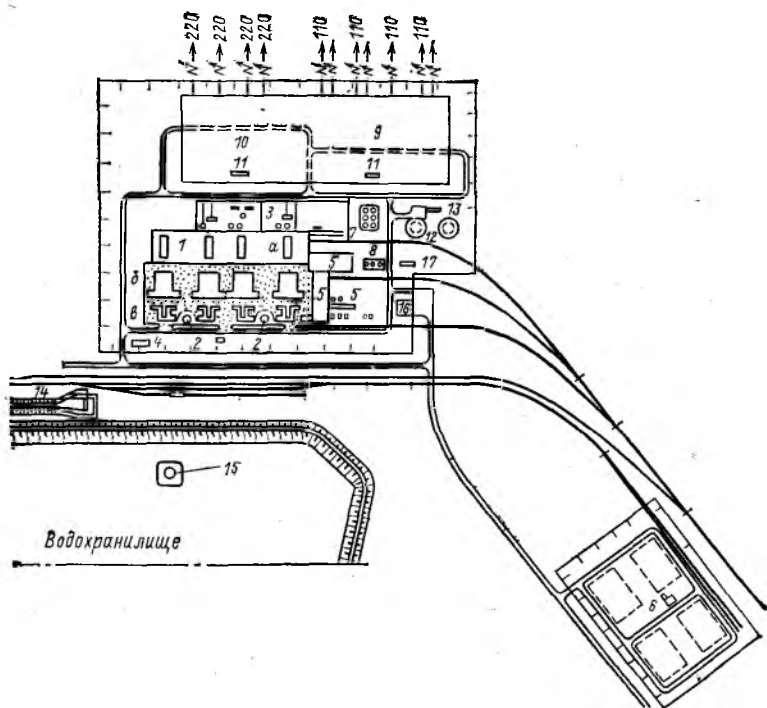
Схема генерального плана открытой КЭС 600 МВт:
